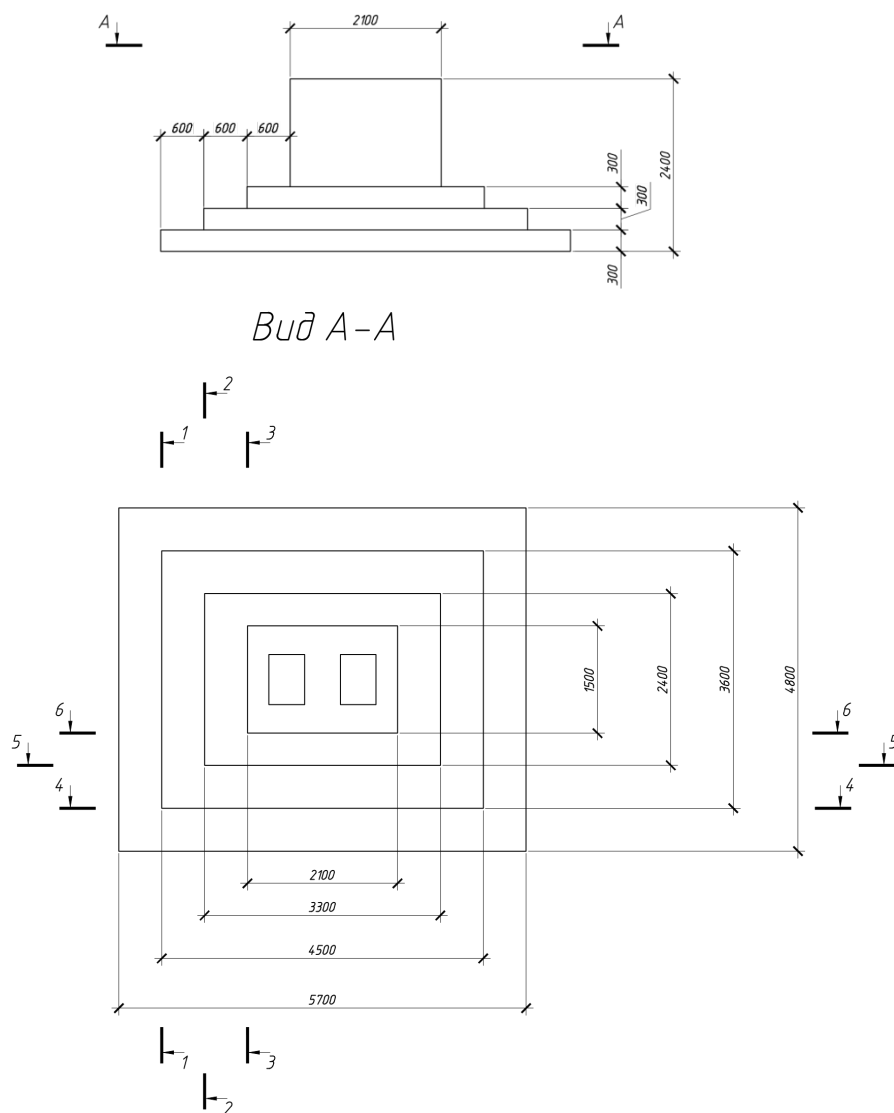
Конструкция фундамента с указанием положения расчетных сечений
